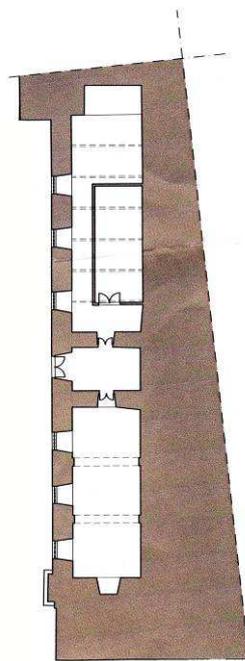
Planta do criptopórtico do levantamento de 2003.
